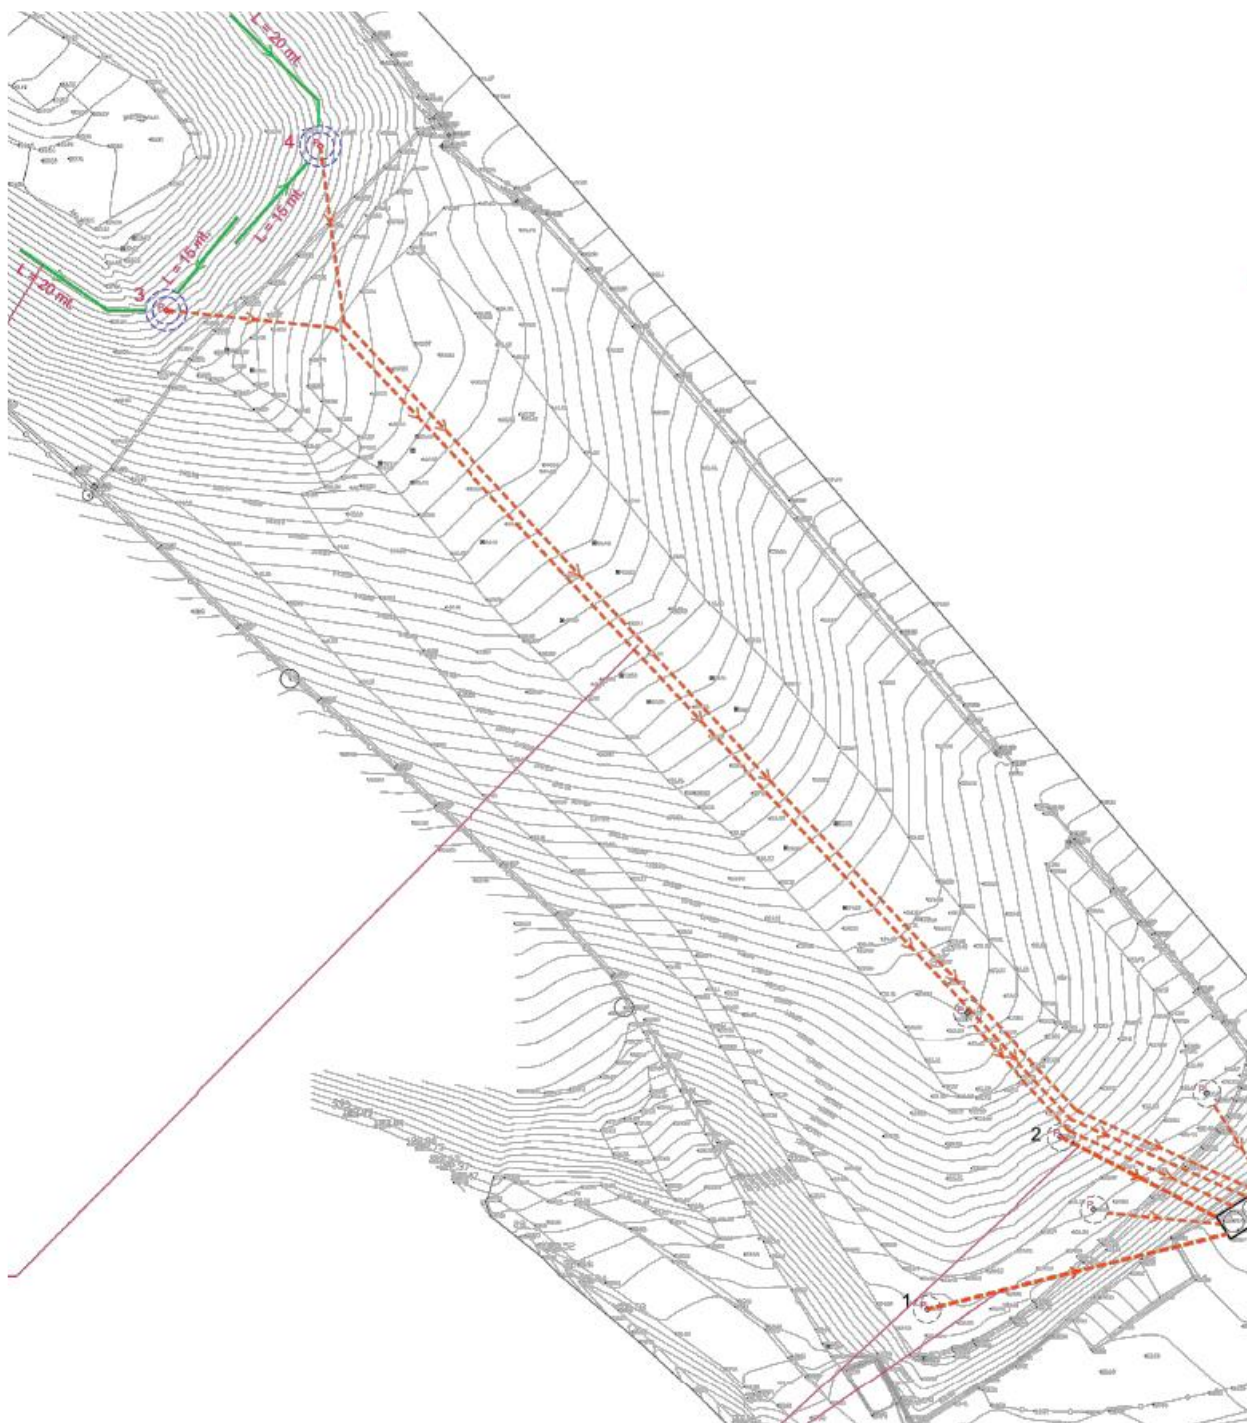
planimetria discarica con l'ubicazione di alcuni interventi
